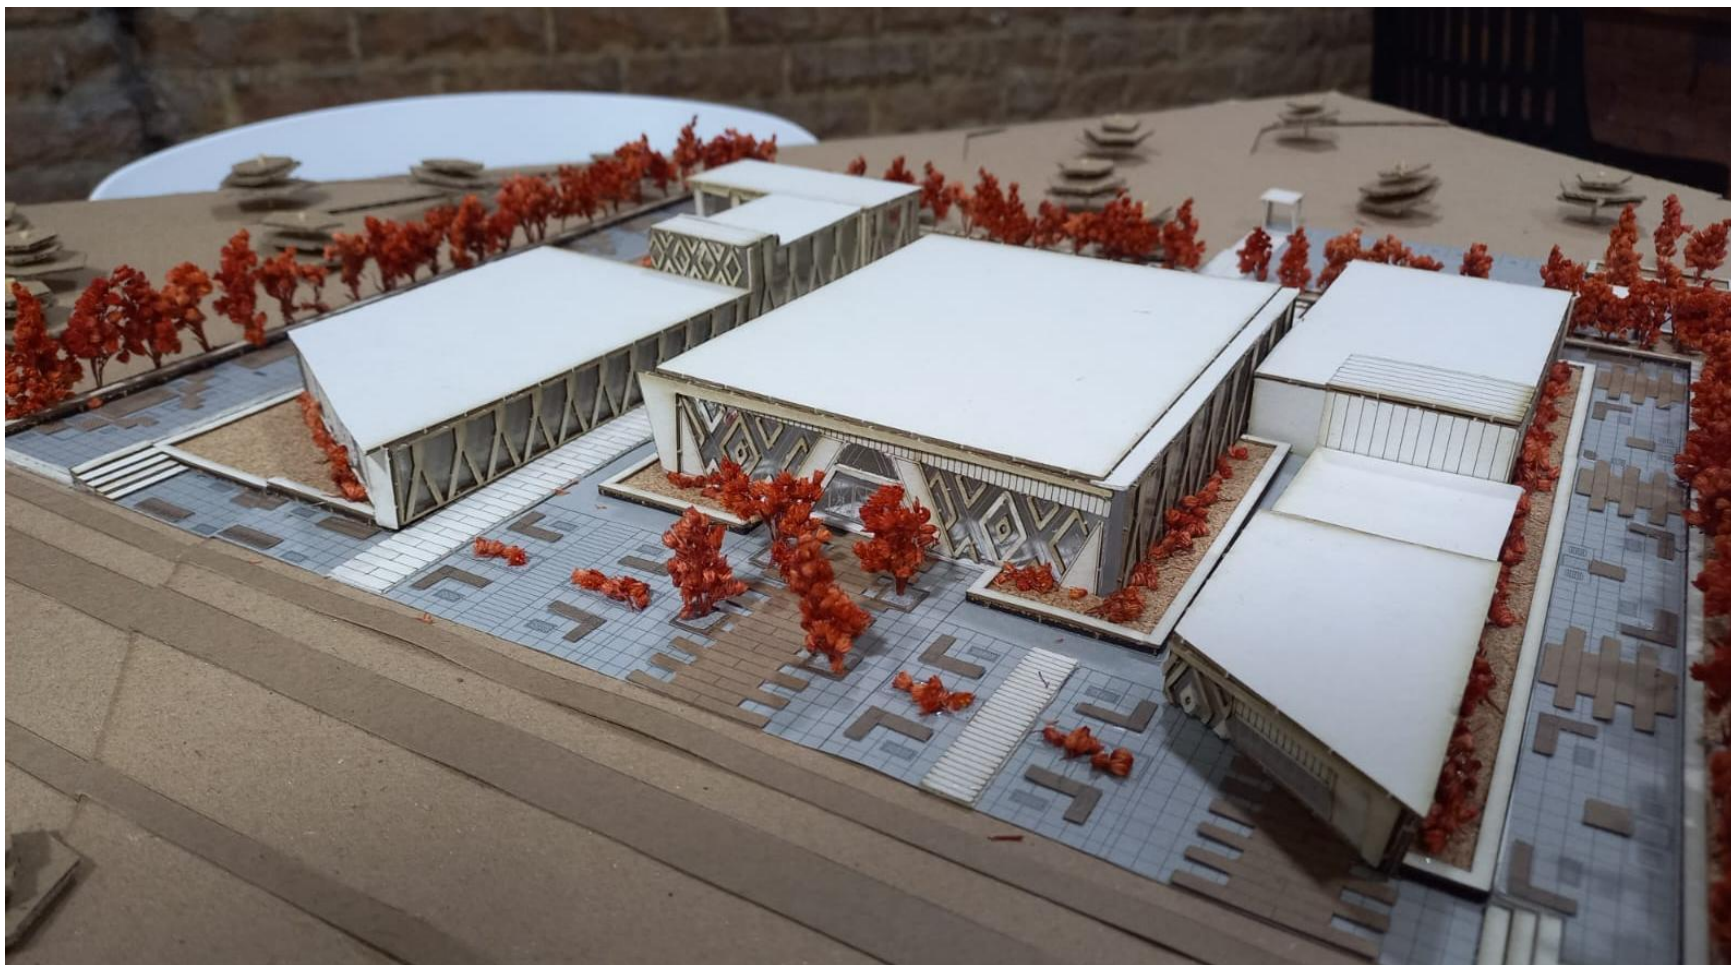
Detalle de volumetría aplicando los conceptos en muestra de la maqueta final. Foto propia.
